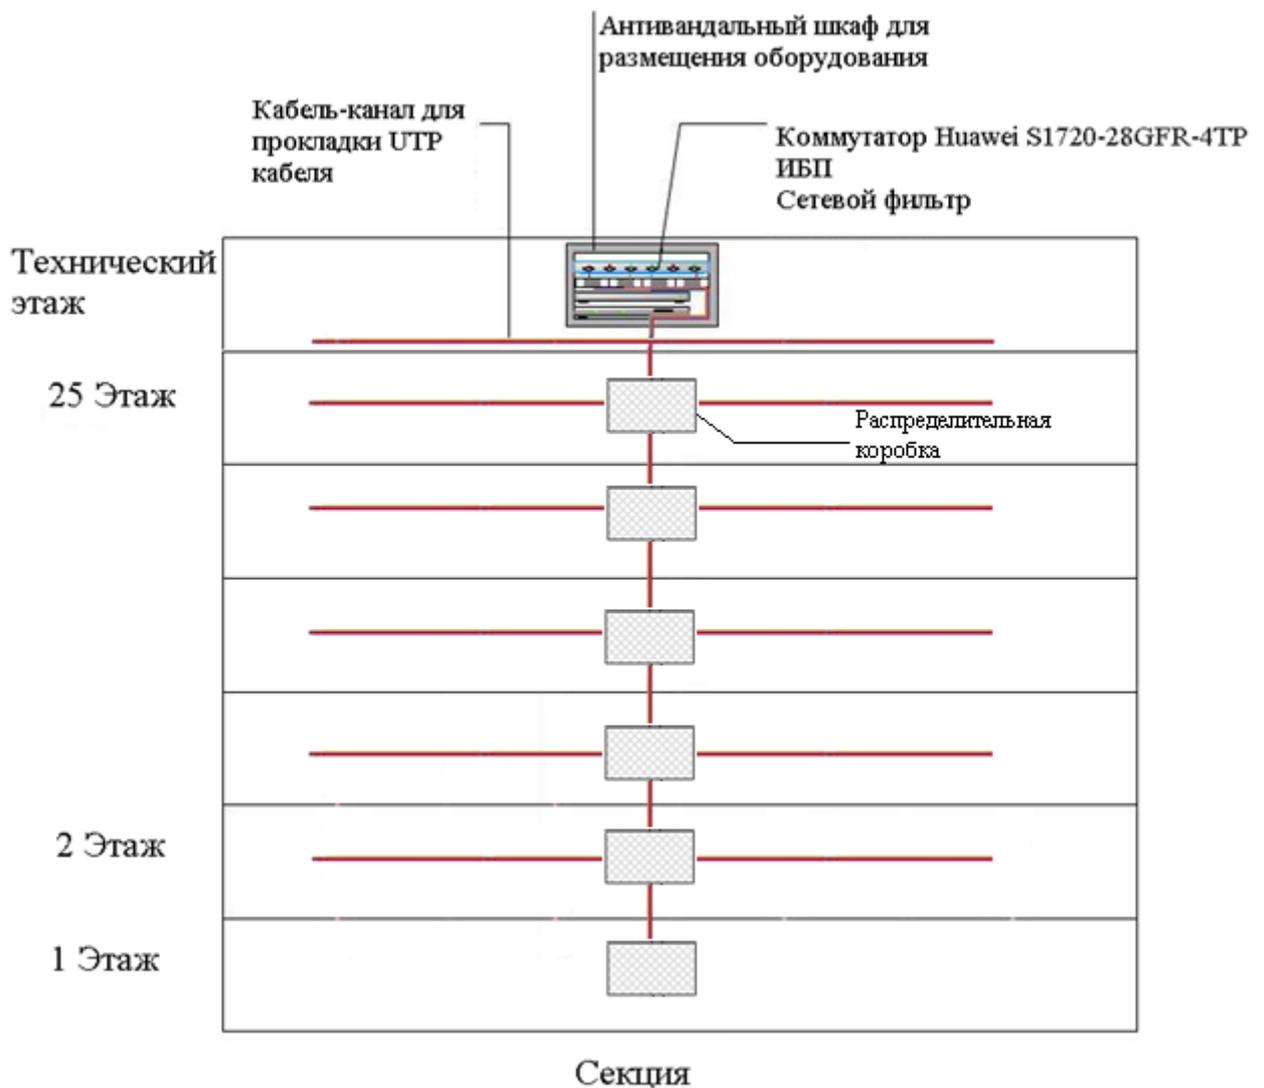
План размещения оборудования доступа в жилом доме
